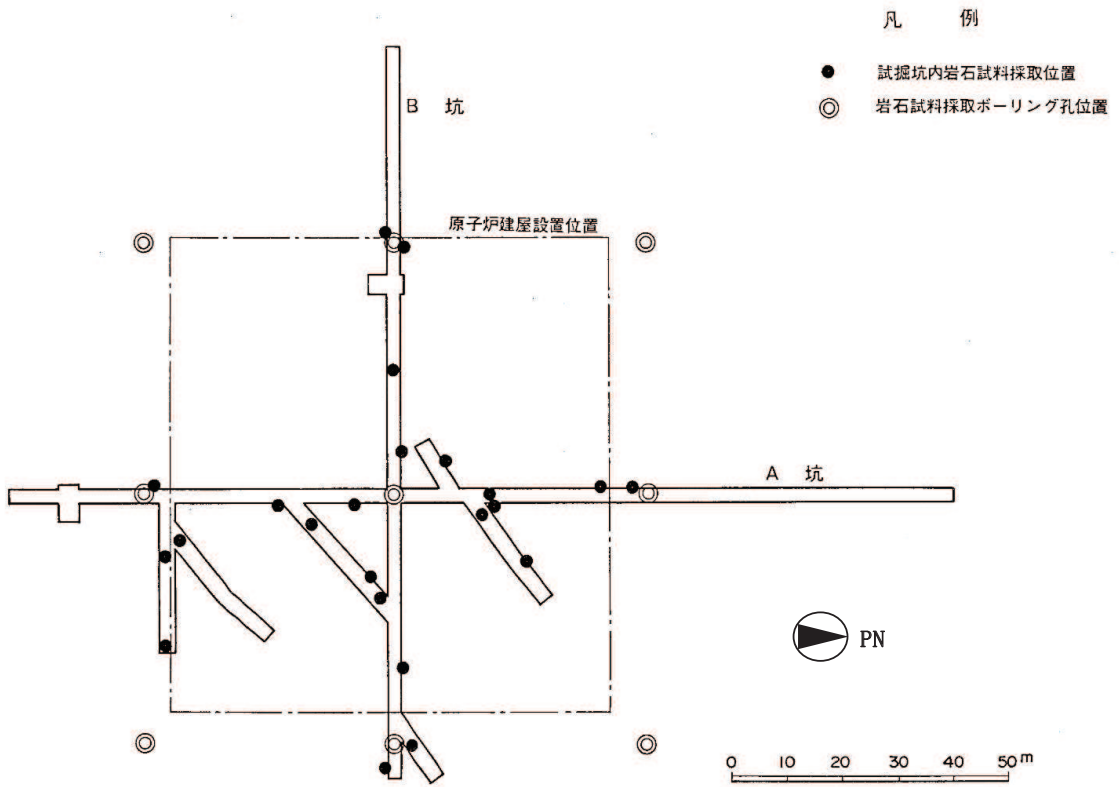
(1) 試料採取位置 (原子炉建屋, 狐崎部層)
